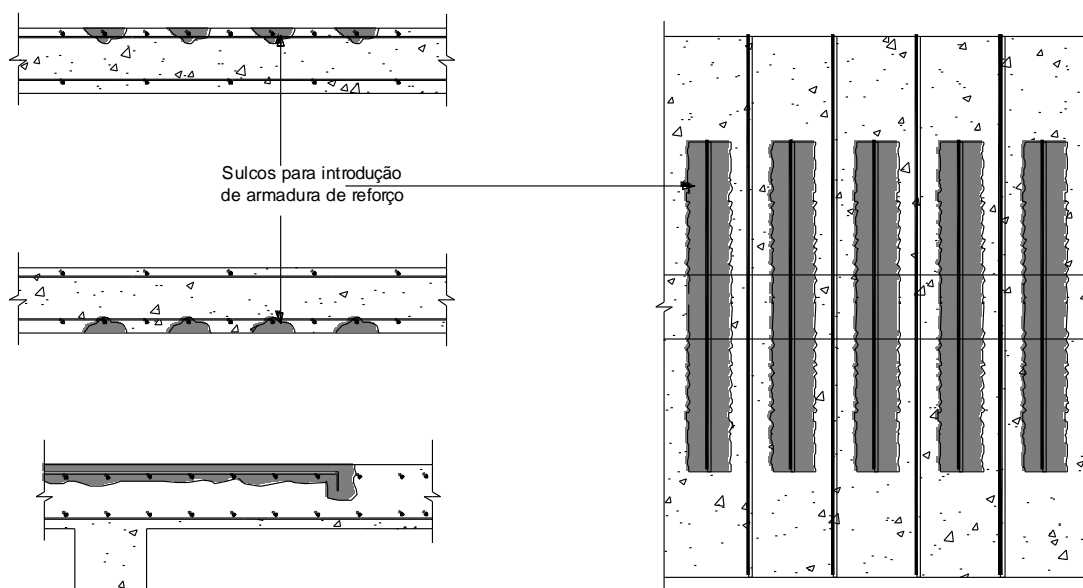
Esquema de reforço de lajes por introdução de novas armaduras em sulcos realizados na secção existente.
